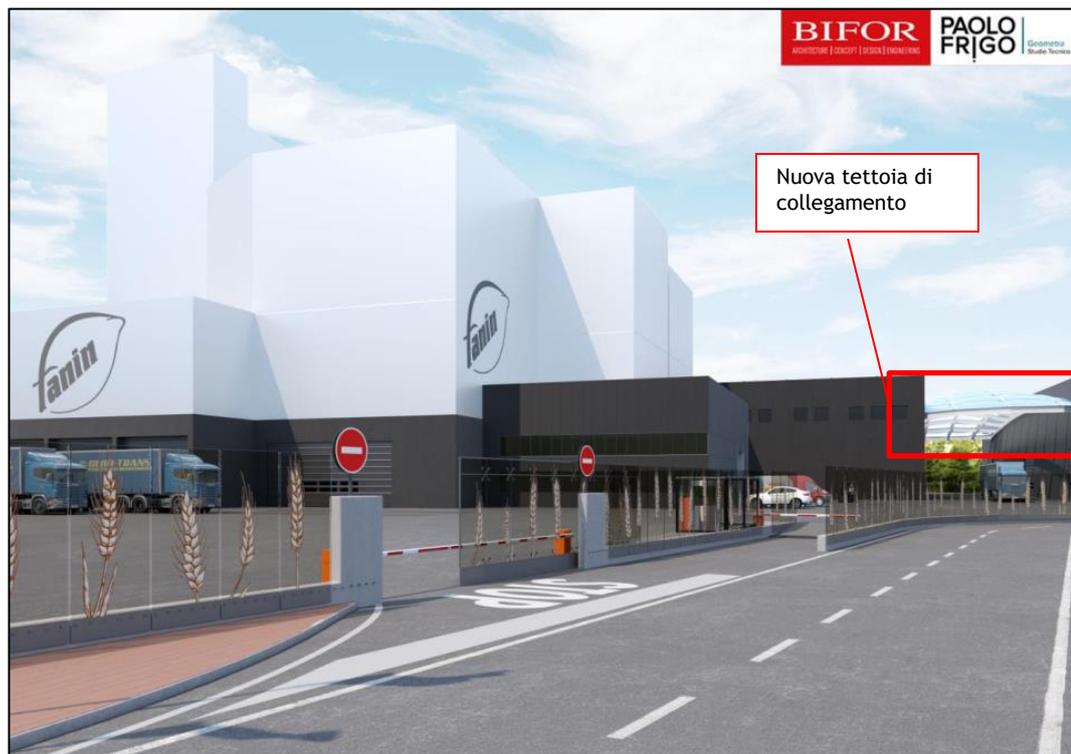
FOTOINSERIMENTO DELL'EDIFICIO CON LE MODIFICHE PROPOSTE
